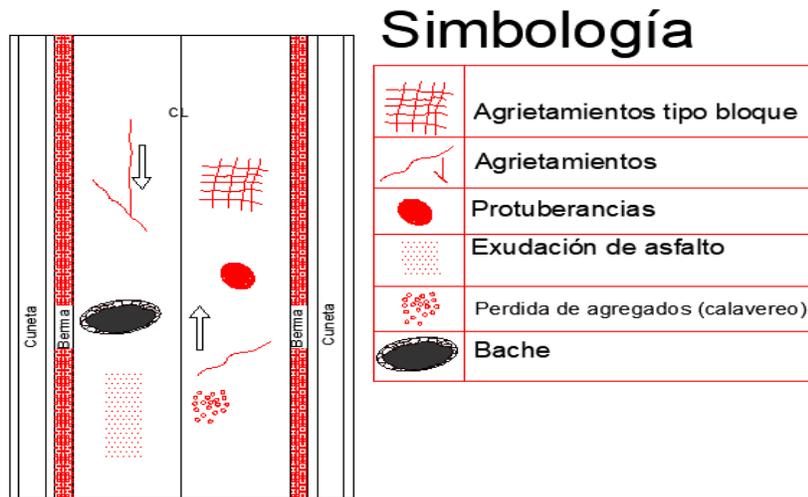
Diagrama de deterioros en pavimento flexible
